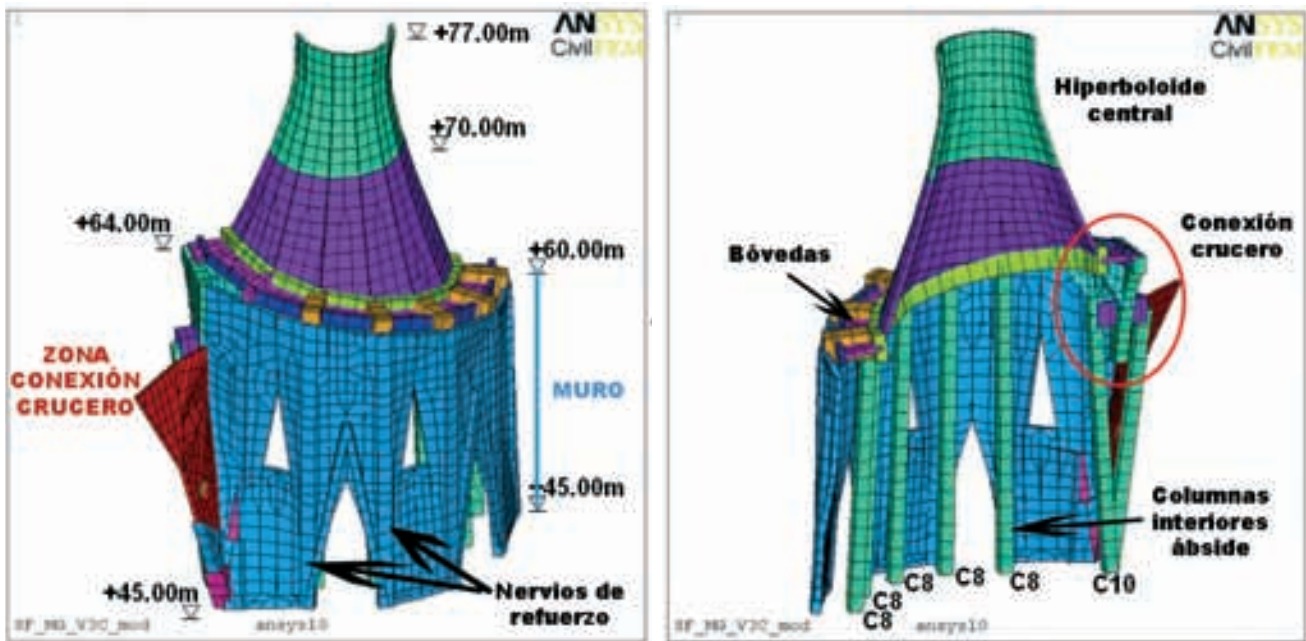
Vista del hiperboloide central del ábside y muro de apoyo (media sección): a) exterior y b) interior
